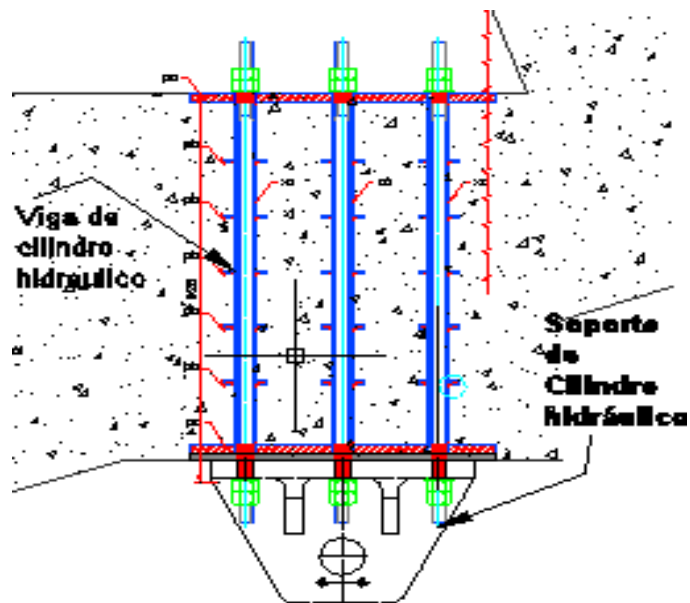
Muestra el conjunto soporte y viga de cilindro hidráulico. Fuente: Propia.
